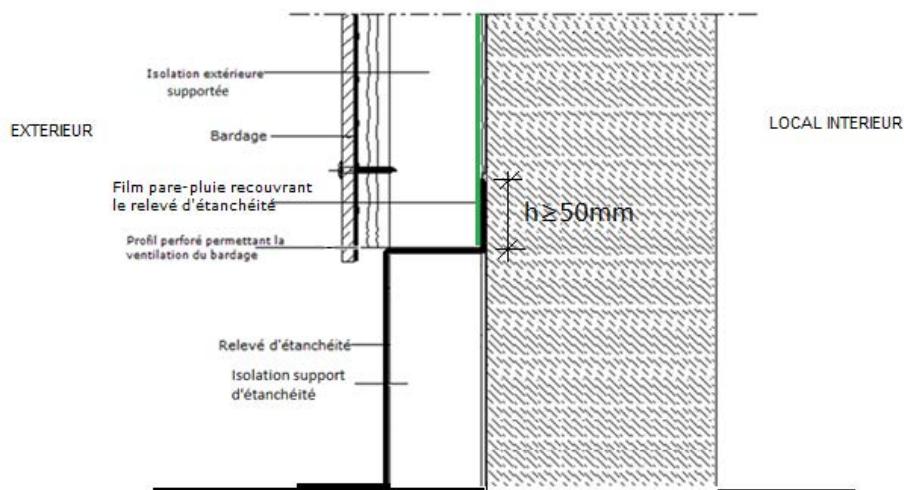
Pied de bardage isolé (isolant support d'étanchéité)
